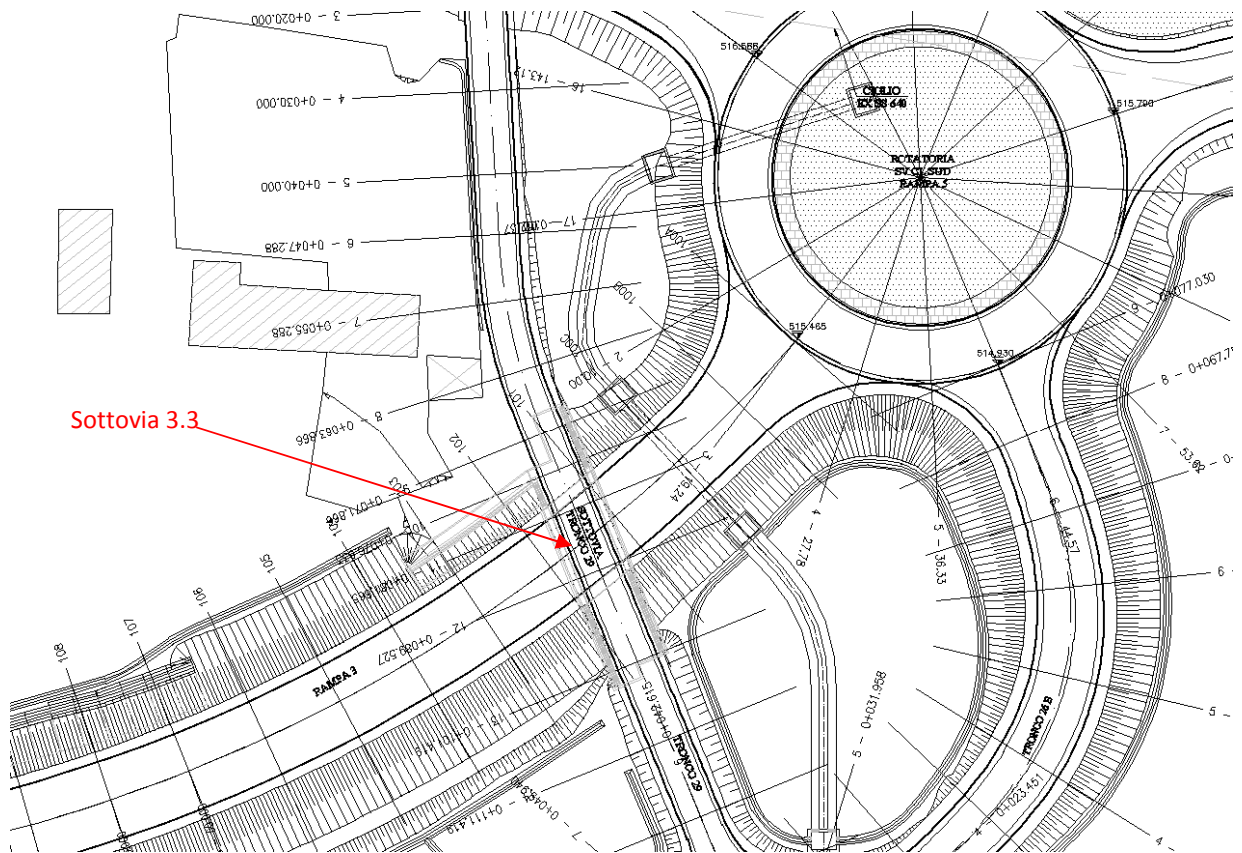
Stralcio di planimetria dello svincolo Caltanissetta Sud
